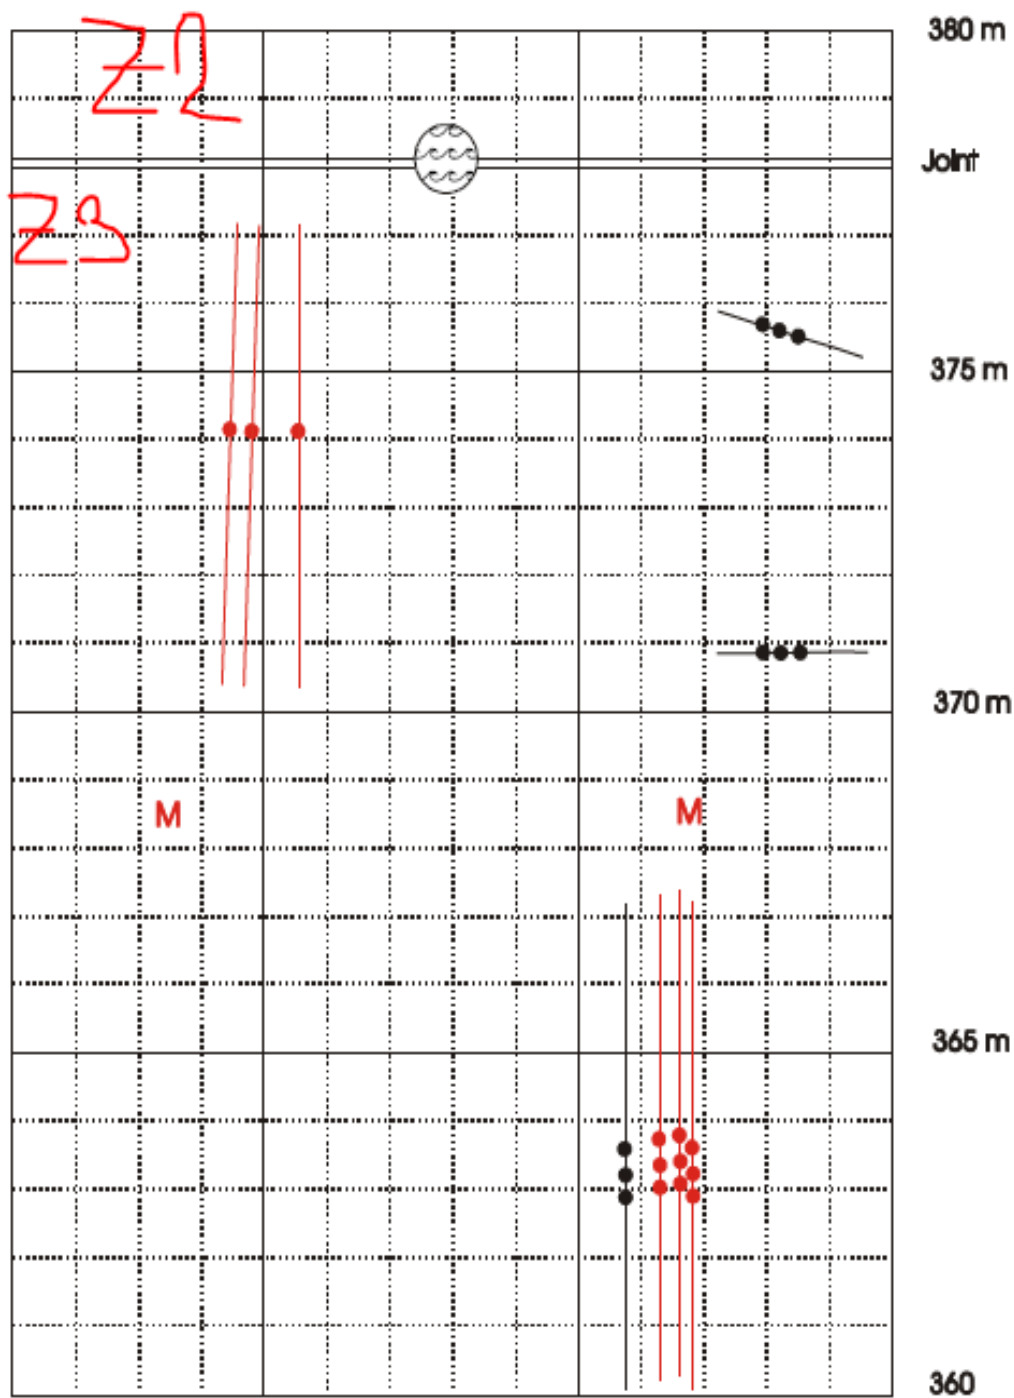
Planche de fissuration travée Sud-Est Zone 3
